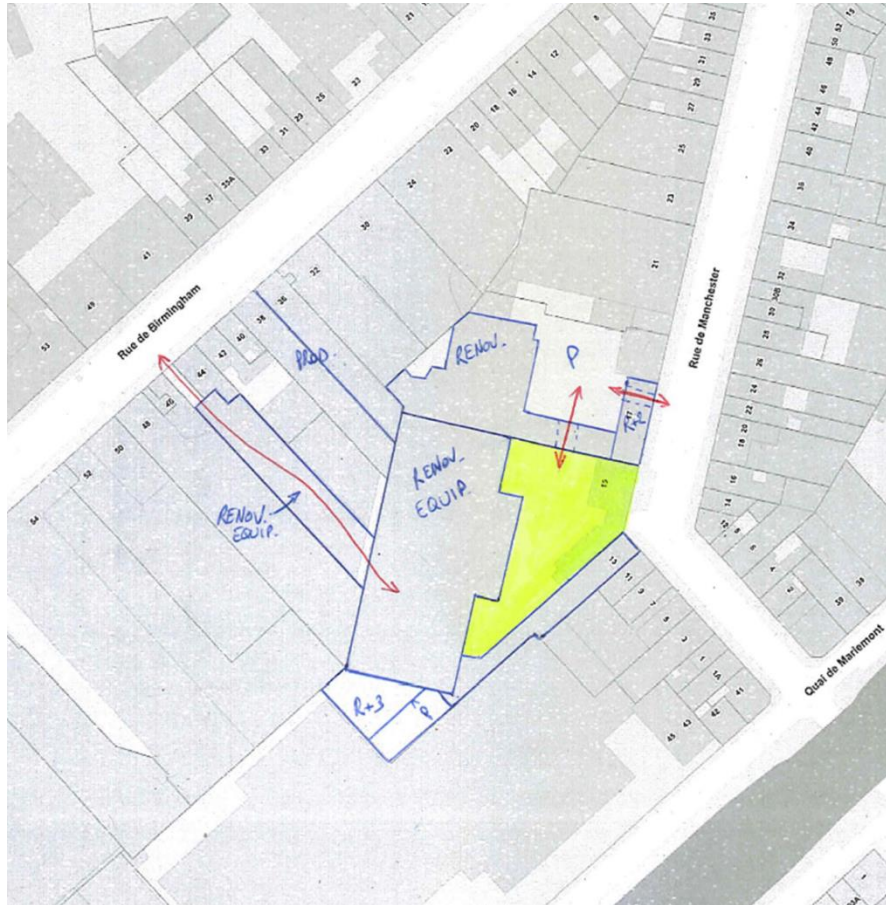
Schéma de principe - variante minimale site 'Liaison Manchester'
